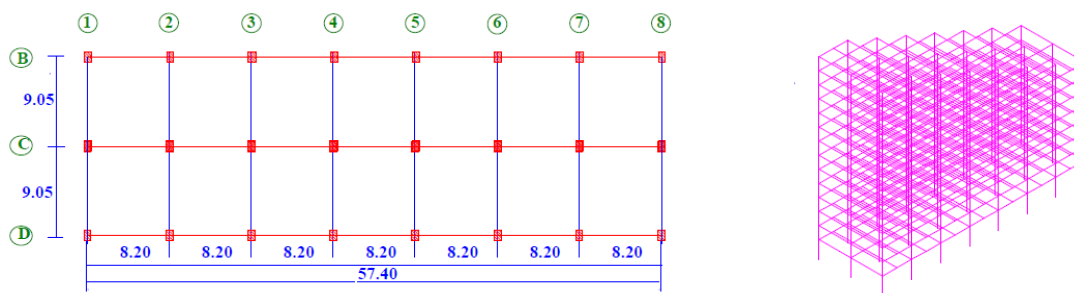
Características en planta y elevación del edificio 2 (Tena Colunga 2004).
